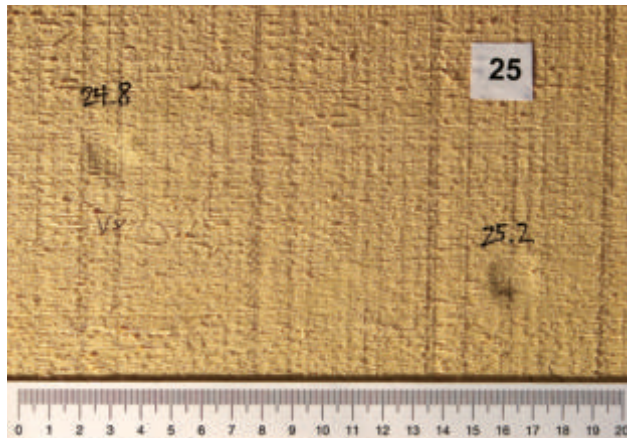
Planche en épicéa sciée et non revêtue, photo Empa.
